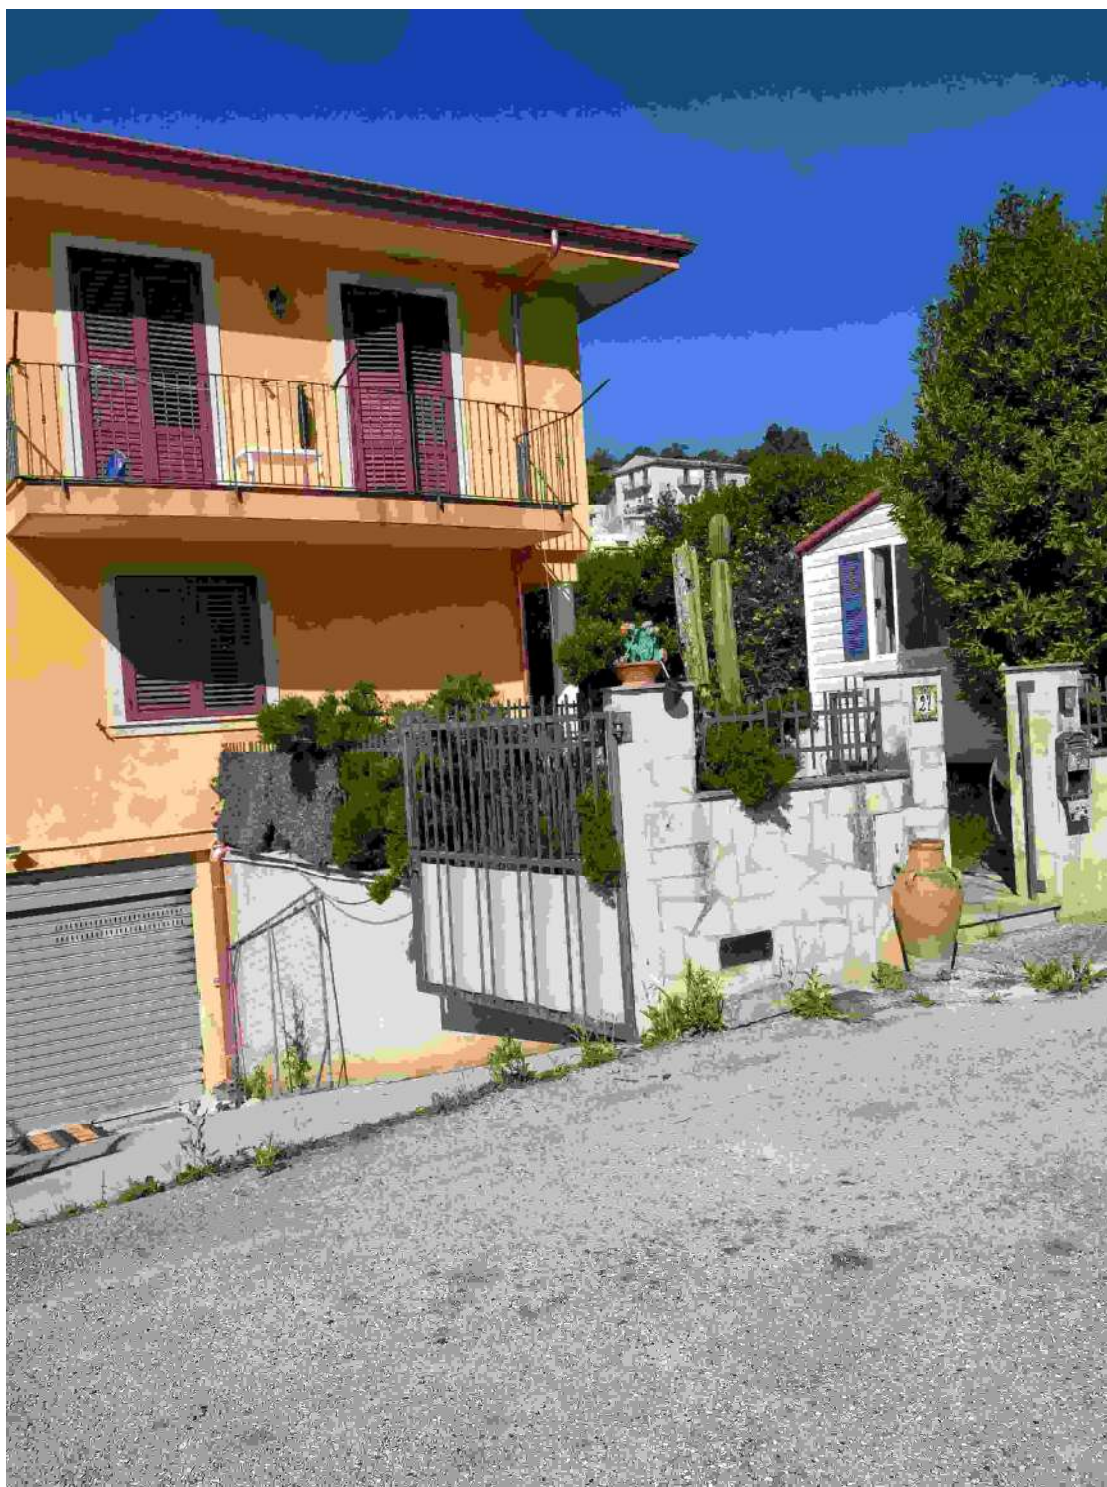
Vista principale edificio lato ingresso, via Siracusa.
